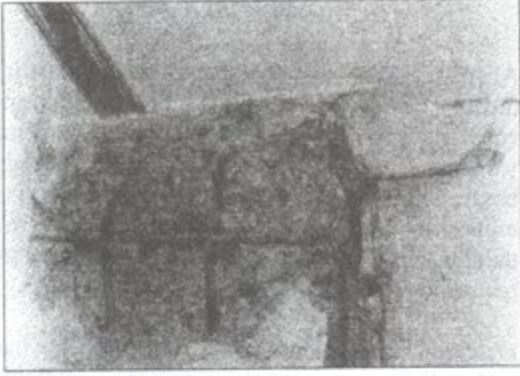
Kolon-kiriş birleşiminde Pas payının ayrılması
